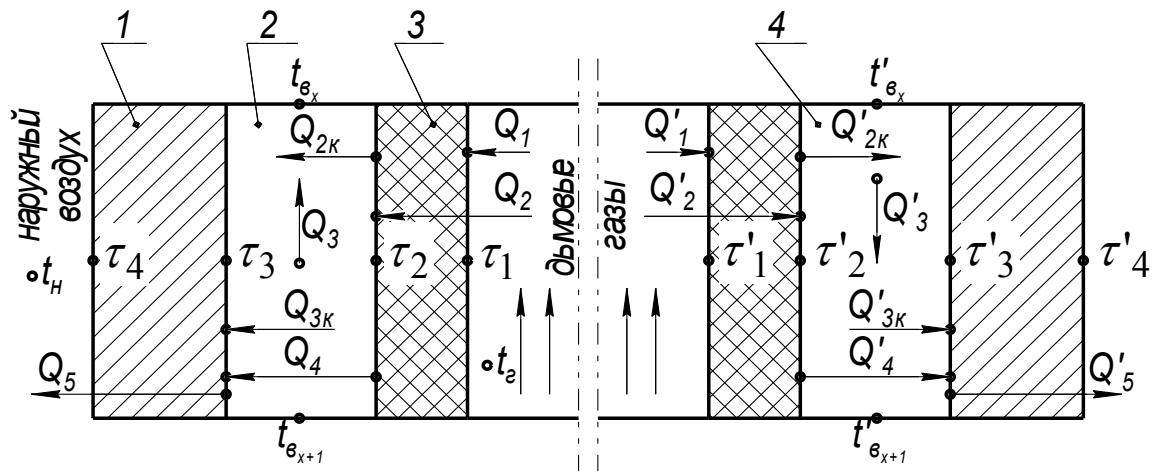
Схема теплообмена в дымовой трубе с вентилируемым воздушным каналом: 1 – железобетонный ствол; 2 – воздушный канал I; 3 – футеровка; 4 – воздушный канал II
